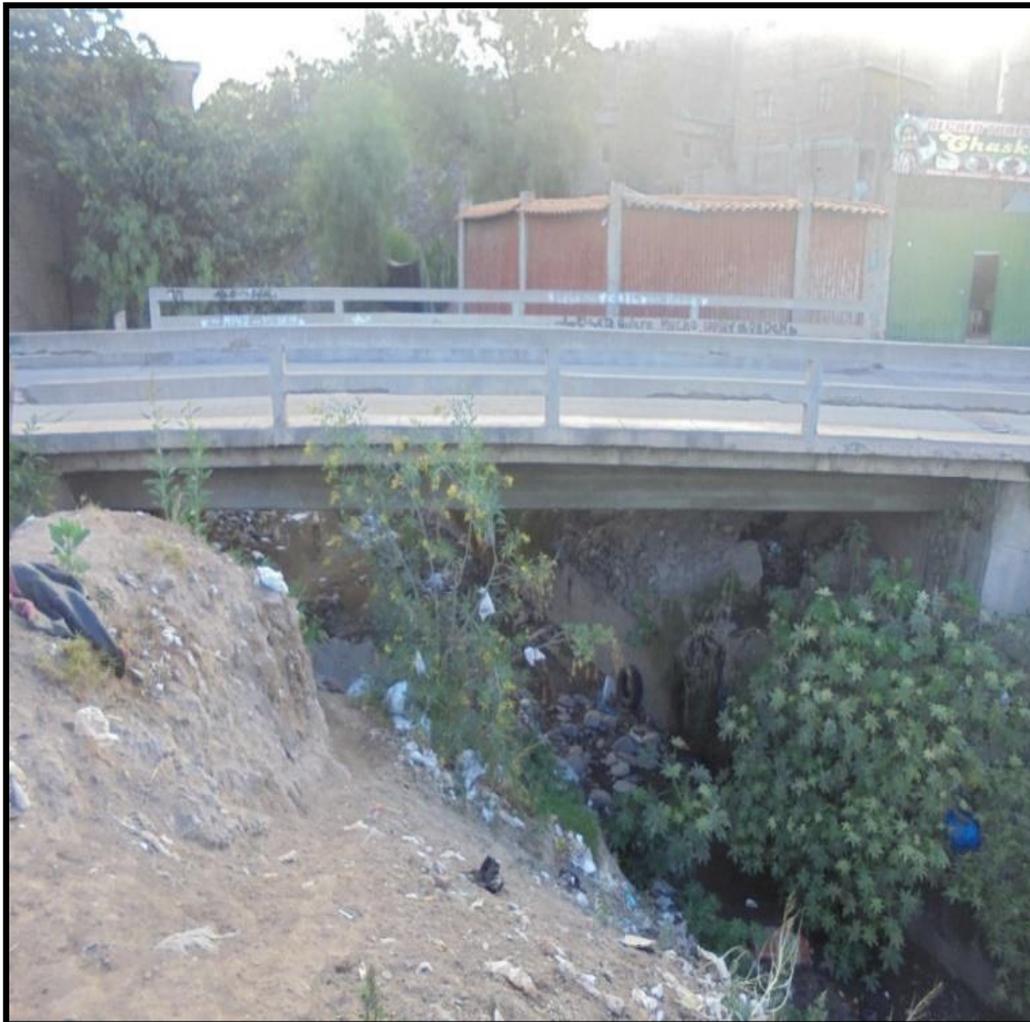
Foto panorámica del puente donde se muestra la exposición a elementos que lo deterioran.
